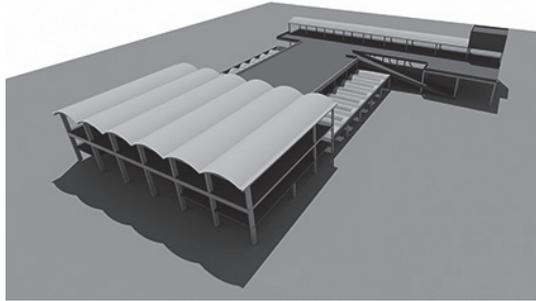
Reconstrucción digital del sistema estructural del edificio Volkswagen (1955).
